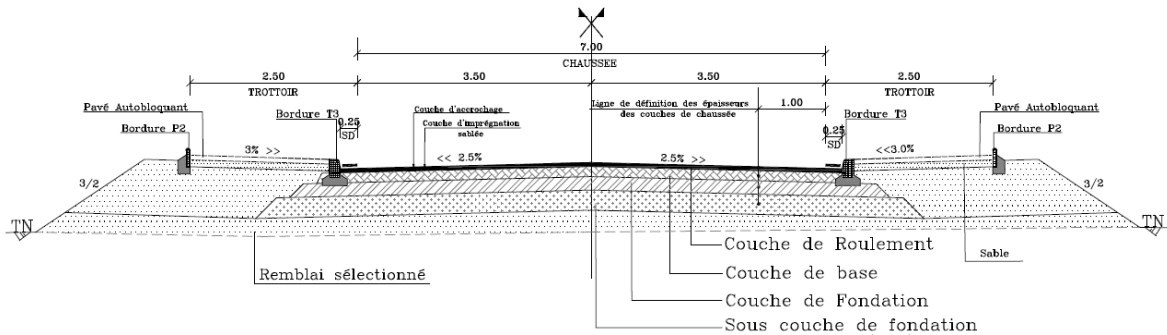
Profil en travers type des traversées urbaines sans aire de stationnement
